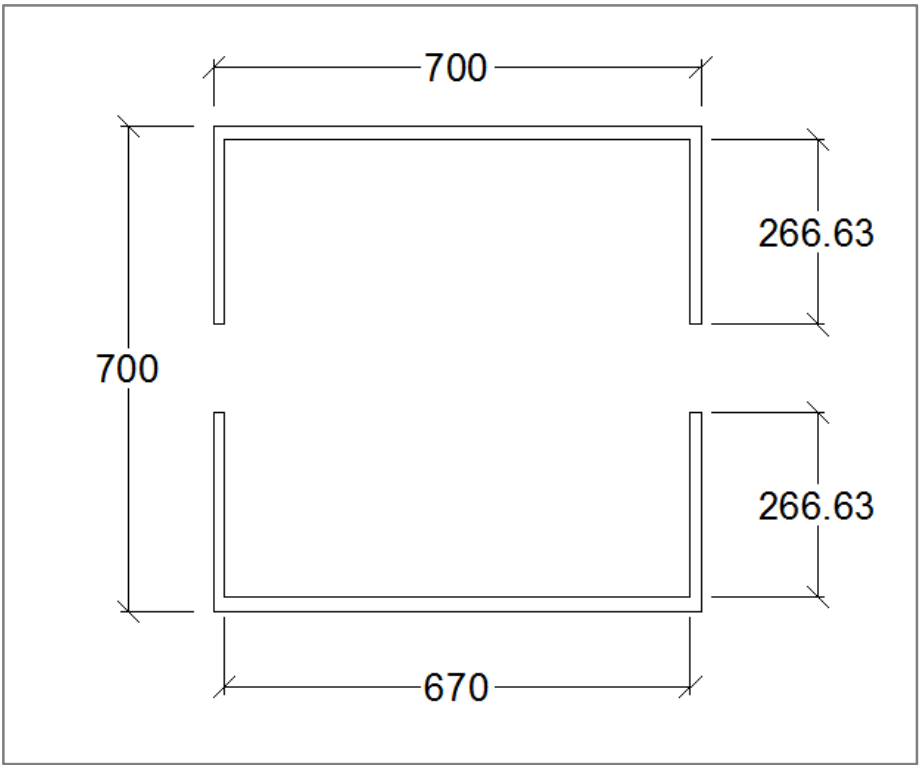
Sección reducida por flector de eje 2 en vigas longitudinales de pasarela (cotas en mm)
